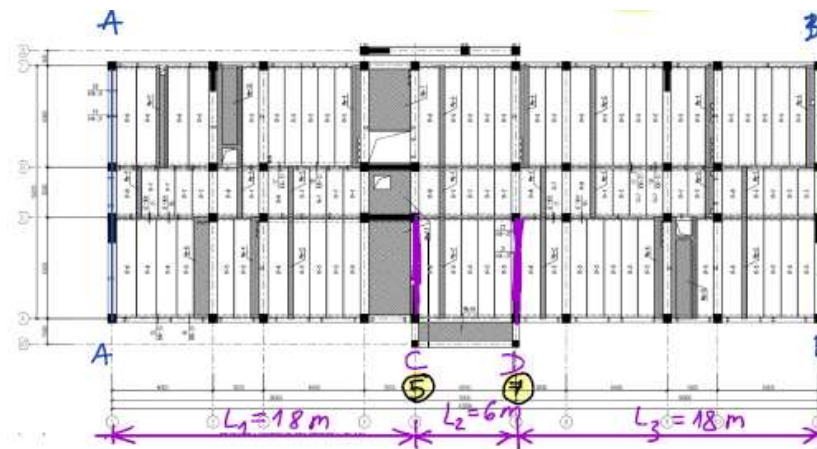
Альтернативная схема с жесткими ж/б стенами – балка на опорах А, В, С, D
